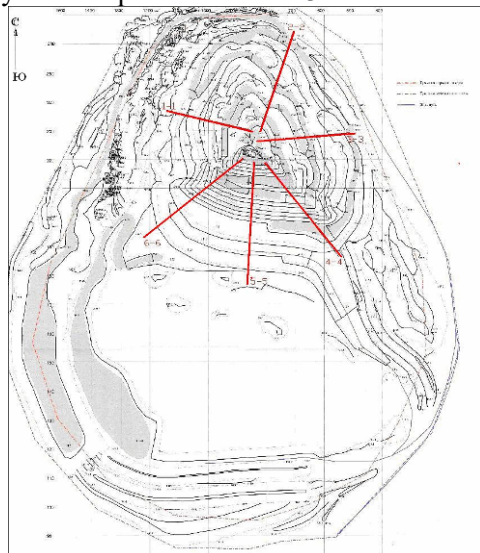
Расположение расчетных разрезов на плане горных работ Артемовского карьера (проектное положение горных работ на 01.01.2012 г.)
